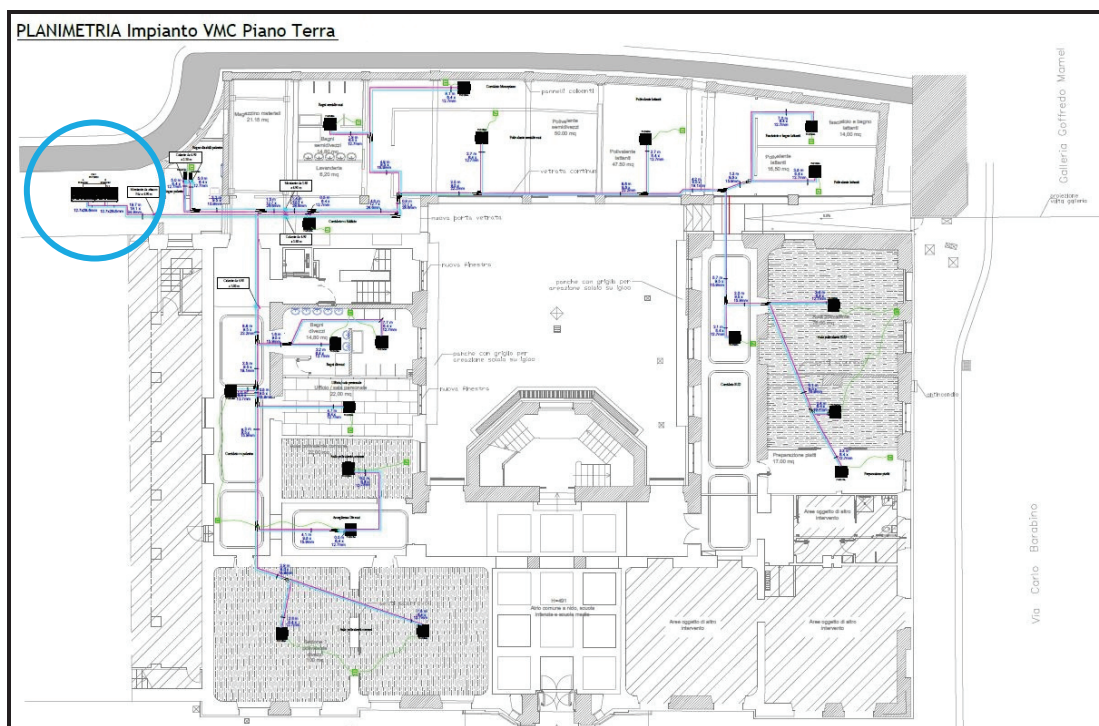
Stralcio planimetrico progettuale con ubicazione dell’unità esterna (cerchio azzurro).
